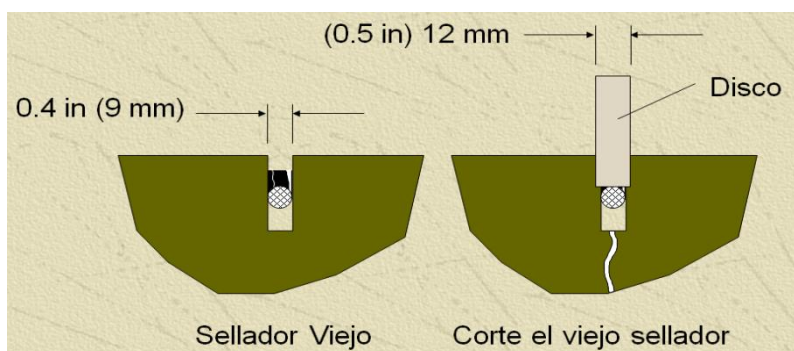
Ensanchamiento de la junta o fisura
